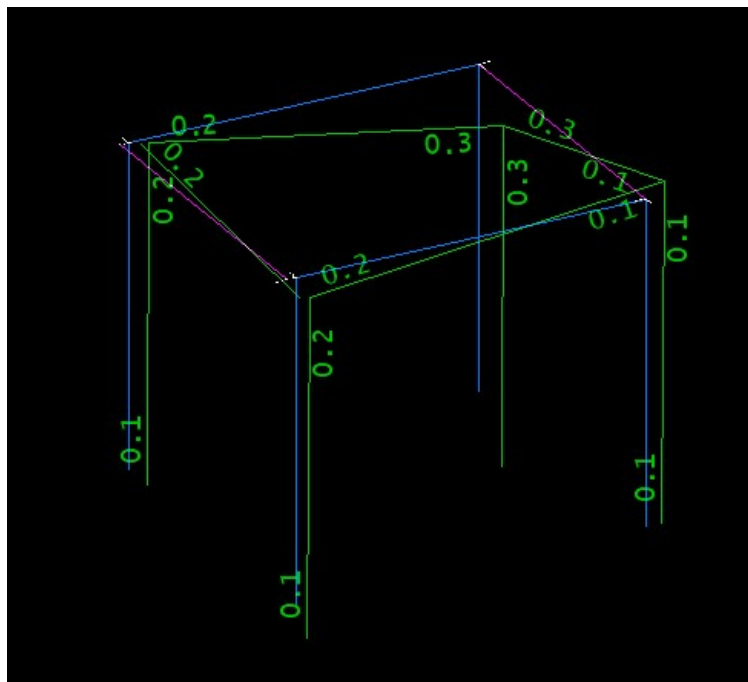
Grelha demonstrando flechas nas lajes do Pavimento Cobertura.
